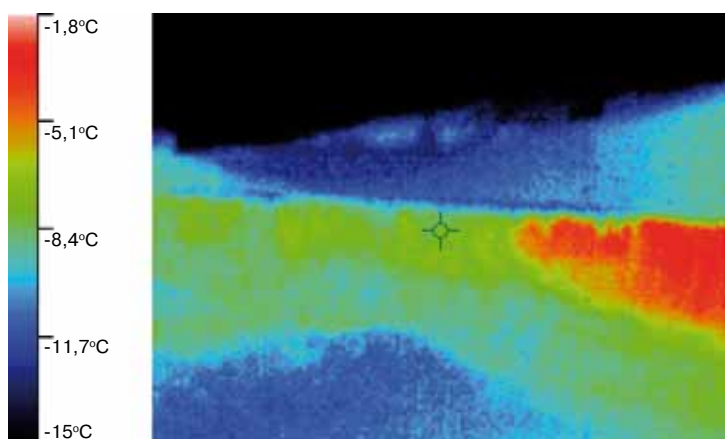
Тепловизионная съемка парапета стены с вентилируемым фасадом бассейна
